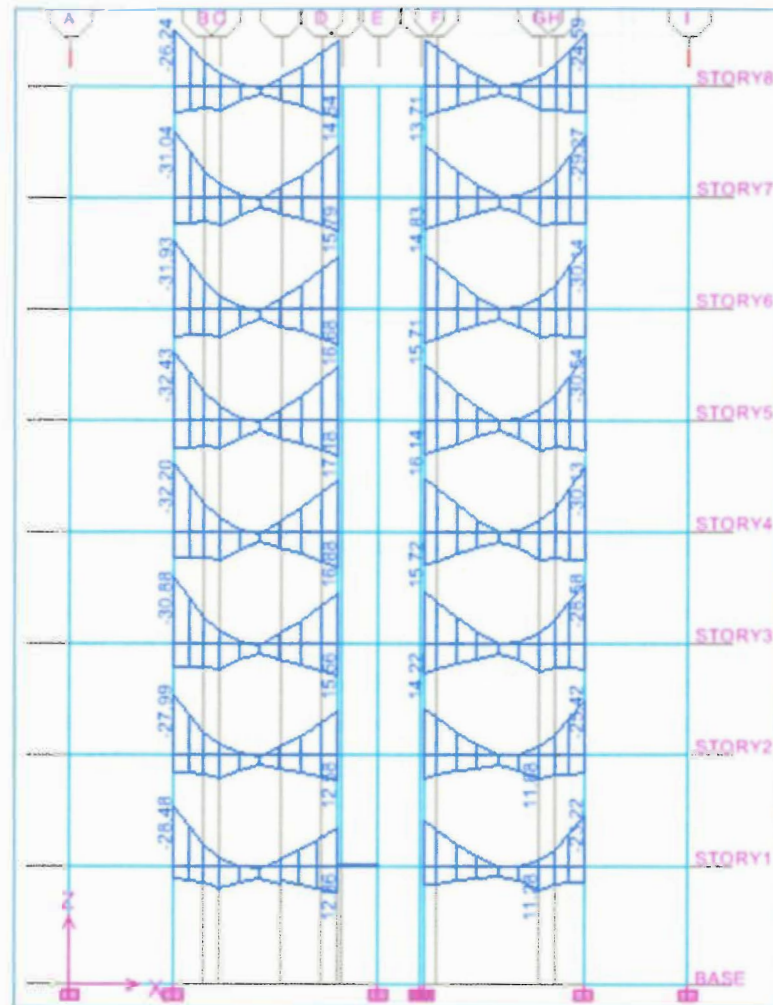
a: Pórtico del eje 3 Viga VT-02 (30x50) del 5to piso
